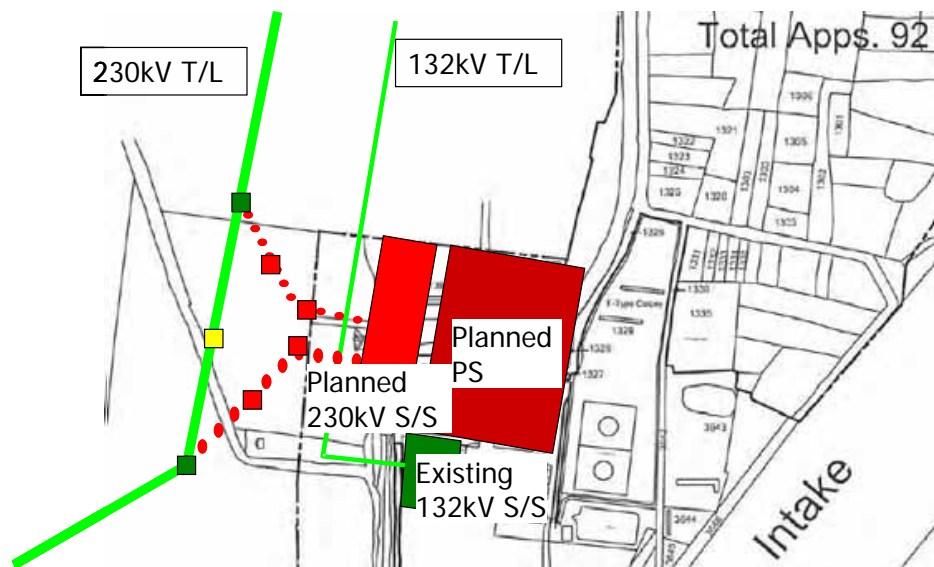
ベラマラ変電所近傍の平面図
